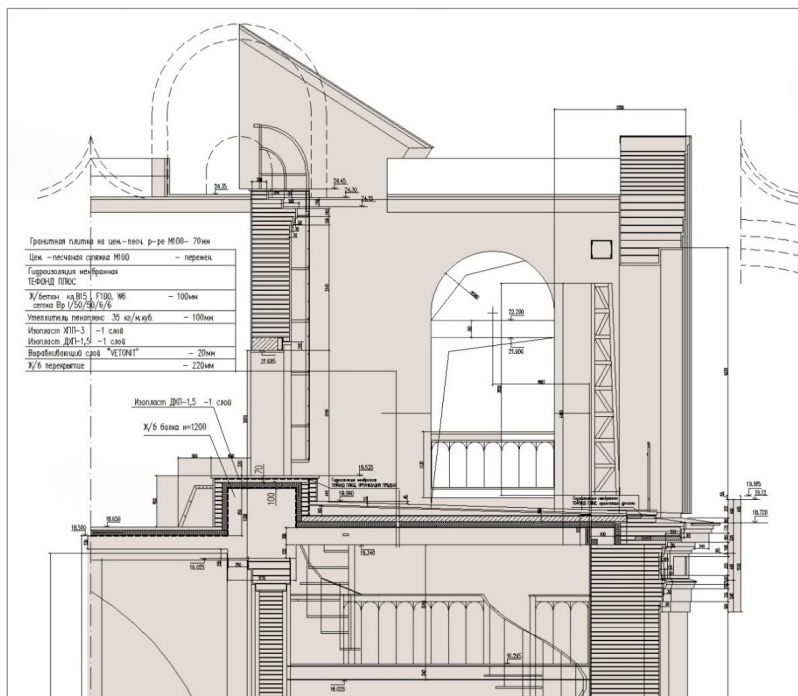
Из проекта по восстановлению Екатерининского собора в Царском Селе. Решение звонницы. В разрез попадает арка портала звонницы и проём раскрытия на восток с лестницей, ведущей на кровлю. Напротив – арочный проём с малой колокольной балкой
